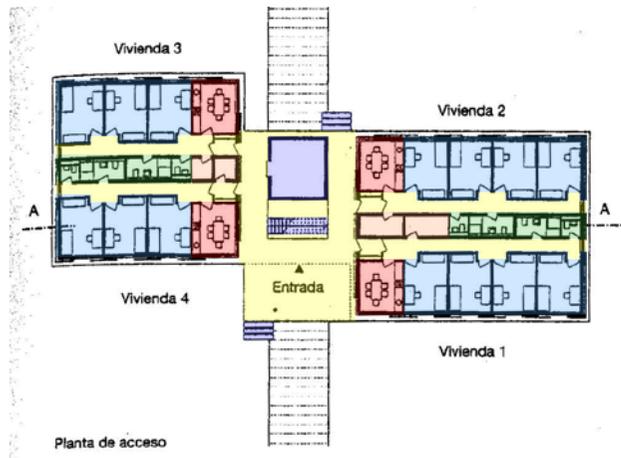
Residencia de estudiantes en Landrain, planta general. Fuente: Neufert (2009).
